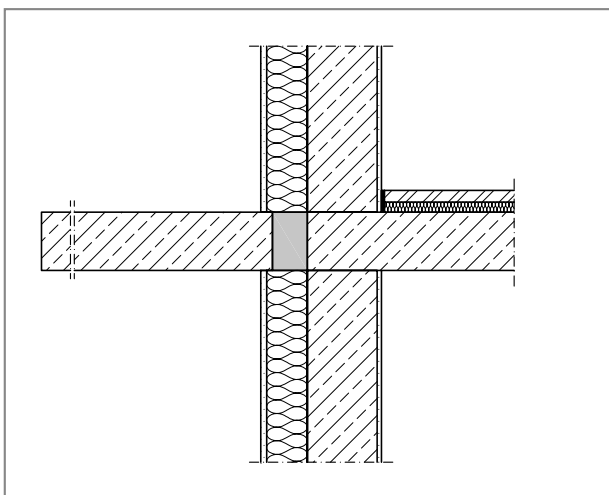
Rappresentazione di una sezione con un modello semplificato di Schöck Isokorb®
